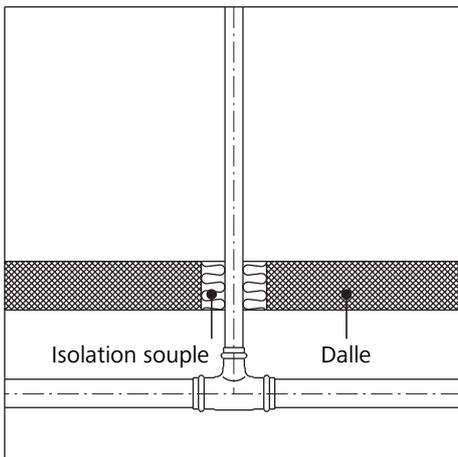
Traversée d'un mur ou d'une dalle par un tuyau
